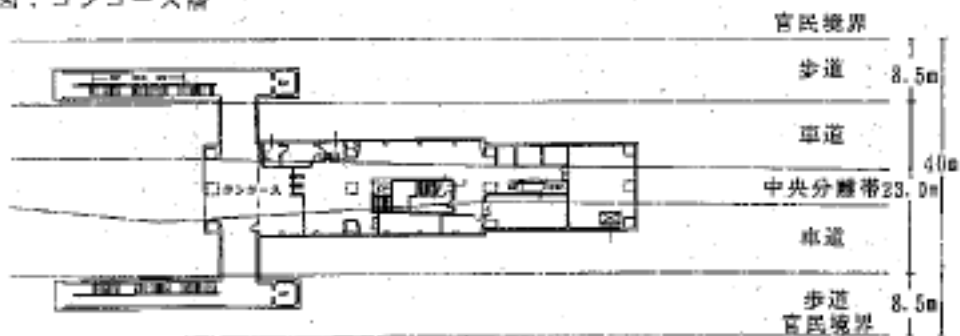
(2) 駅舎部の平面図 (標準駅)
